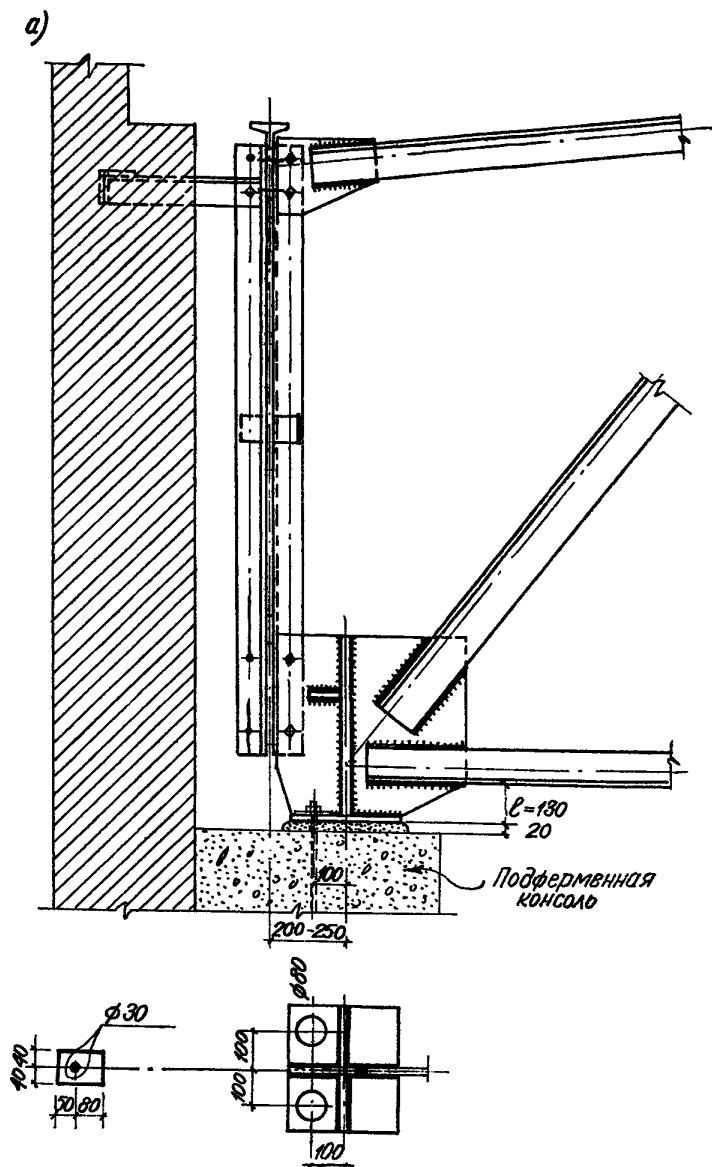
а. Опираие стропильных ферм на железобетонные колонны, унифицированное для крайней и средней опоры
